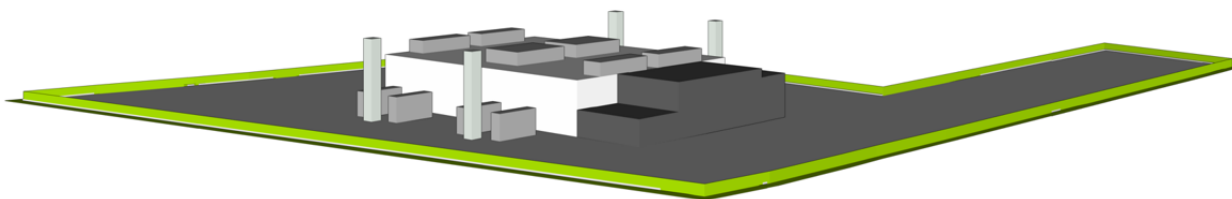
ricostruzione 3D delle volumetrie degli impianti del nuovo Data Center 3D e delle misure di mitigazione a verde (immagine sotto) previste lungo il lato sud ed est del perimetro. La prospettiva è con vista nordest-sudovest
